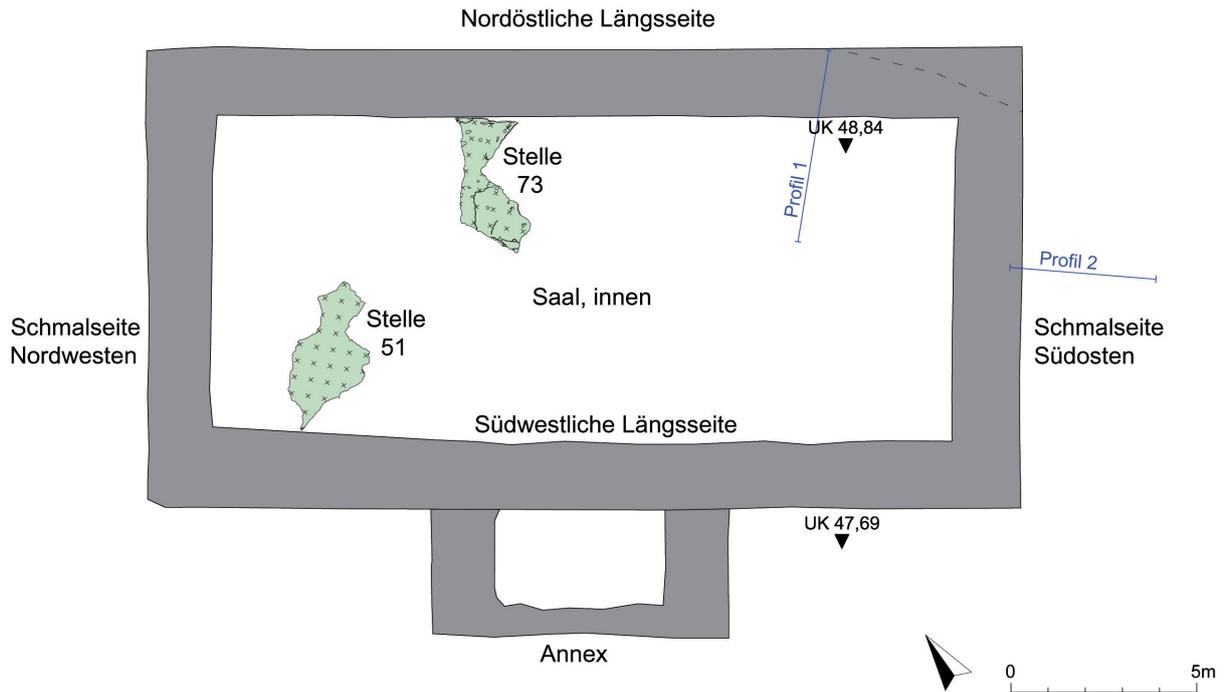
Grundriss des Großbaus an der Antoniterstraße.
